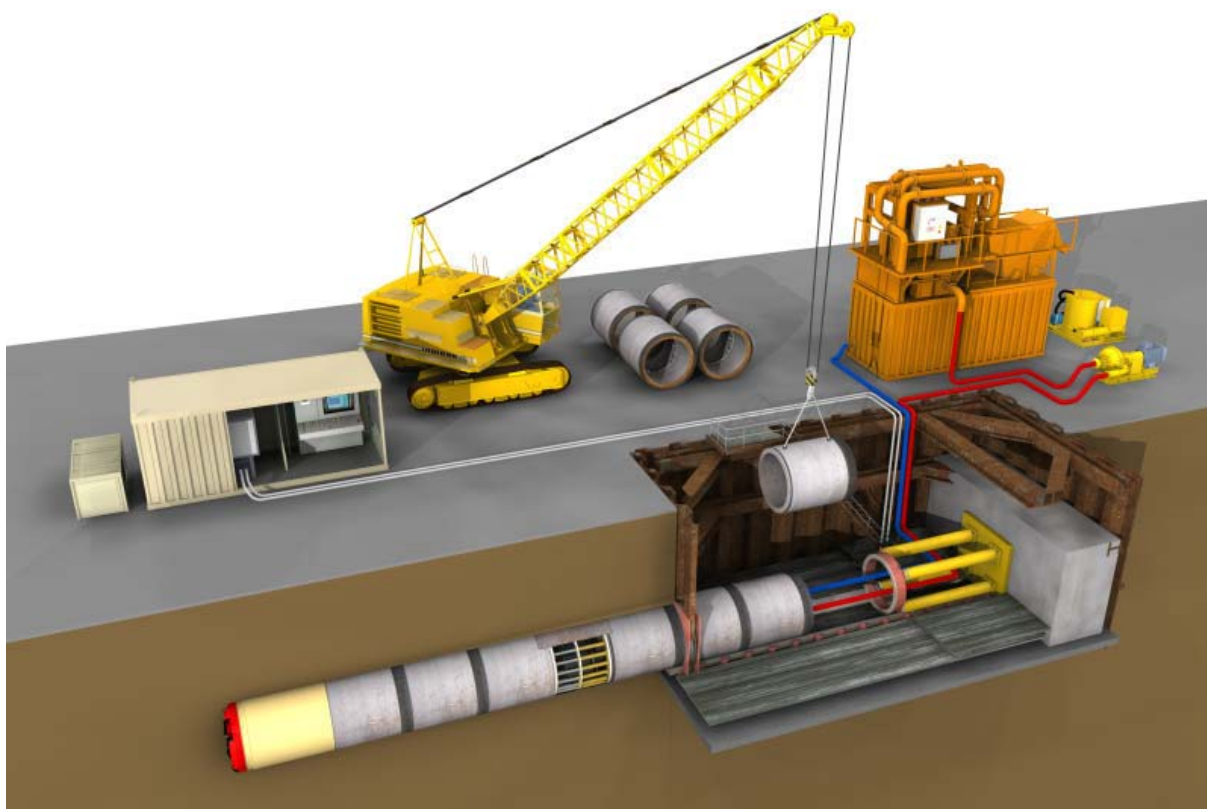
Esquema de túnel por Pipe Jacking (<http://www.victoriatrenchlessolutions.com.au.com>, 2018)
